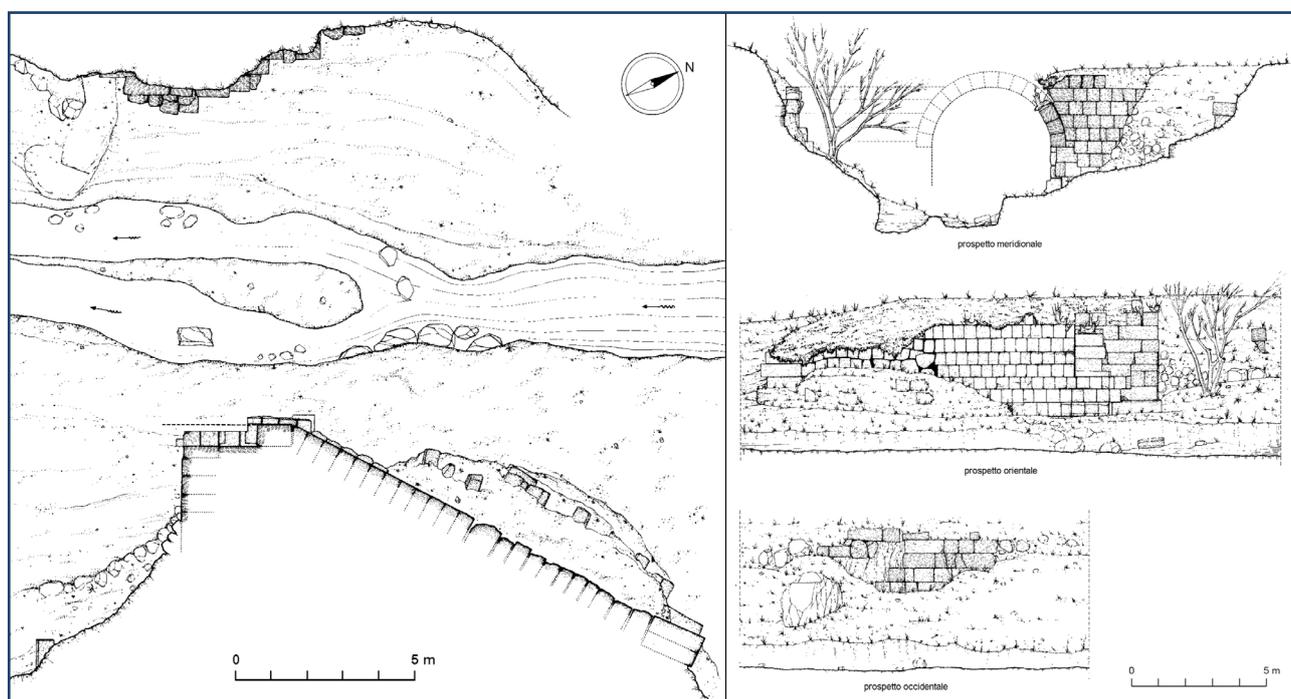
Ponte lungo il Fosso di Valle Canale: pianta e prospetti (rielab. da NARDI 1980, tavv. LXIV-LXV).
